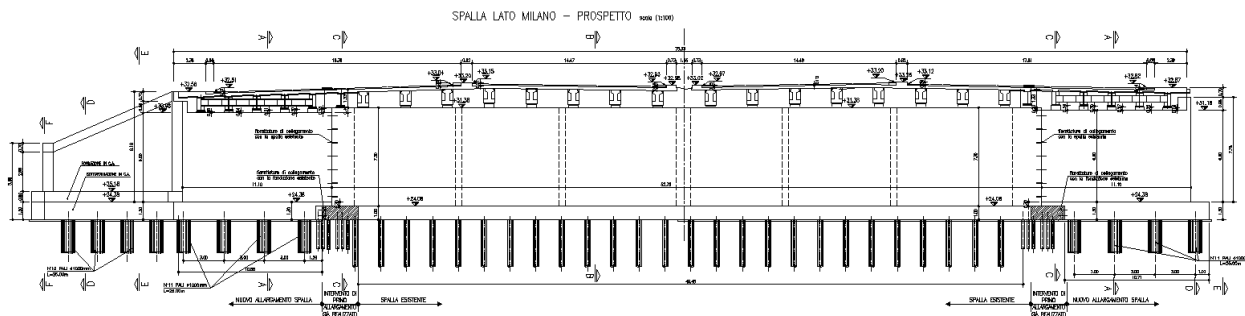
Sezione trasversale spalla lato Milano
